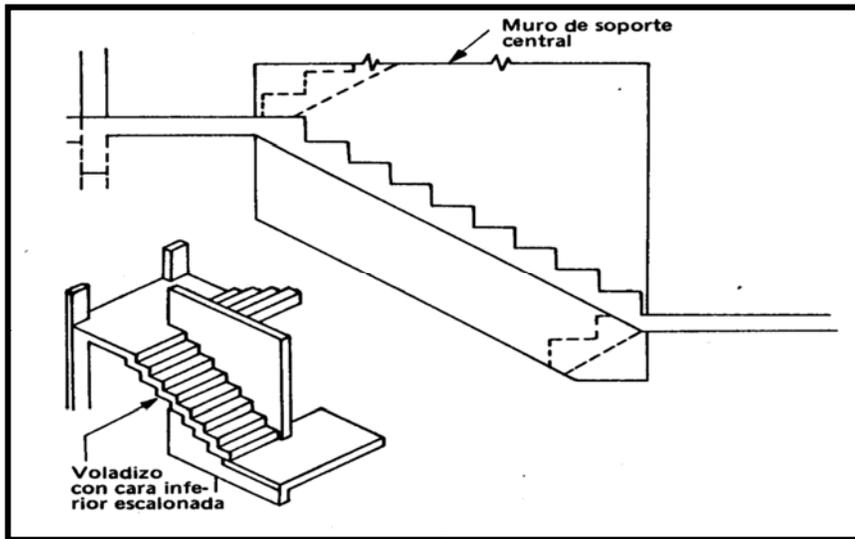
Escalera de hormigón en voladizo con muro de soporte central.
